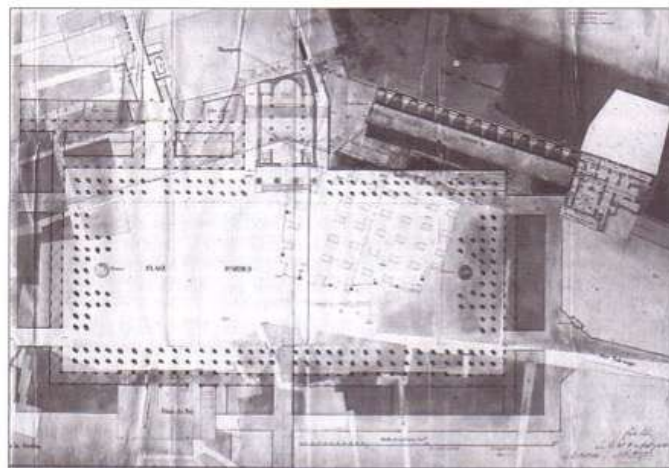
Plan de la place du Gouvernement dressé par Lemerrier le 1<sup>er</sup> novembre 1832
